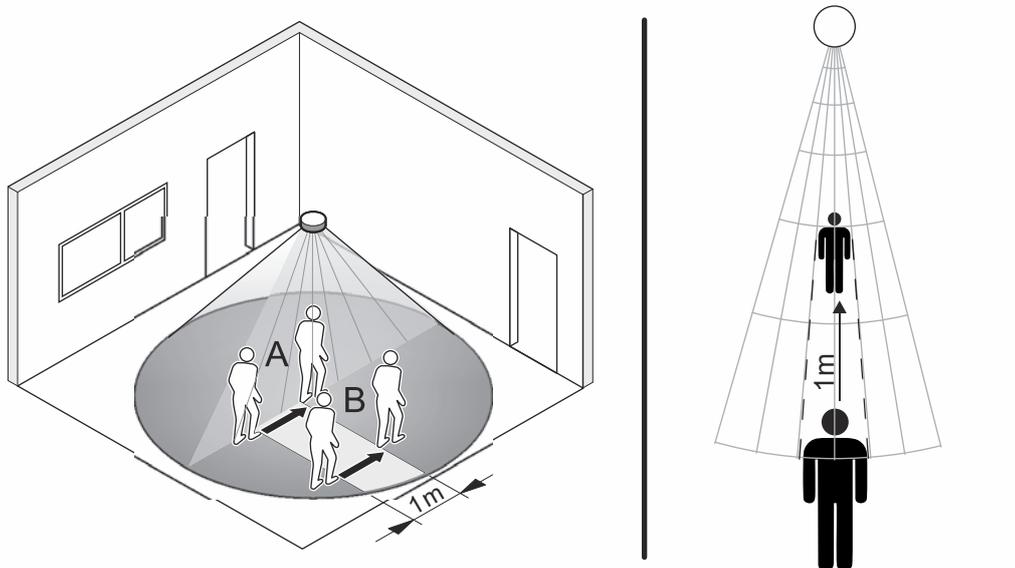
Passaggio longitudinale/parallelo rispetto all'apparecchio
